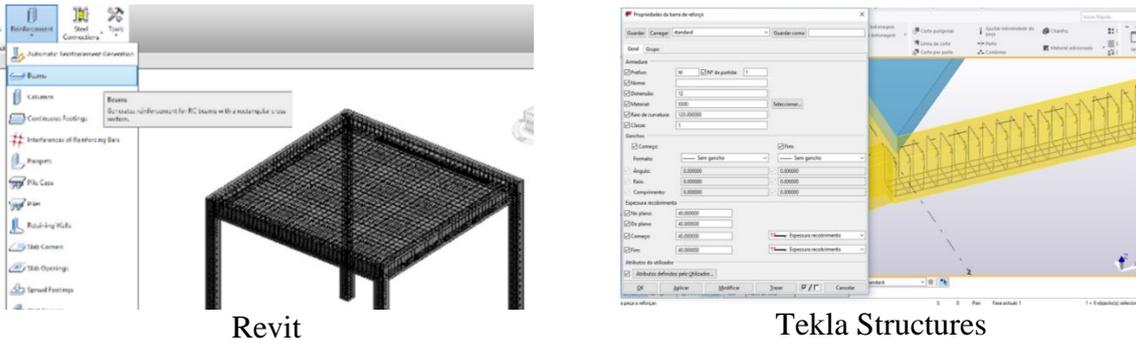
Exemplo de modelação de armaduras em Revit e em Tekla Structures.
